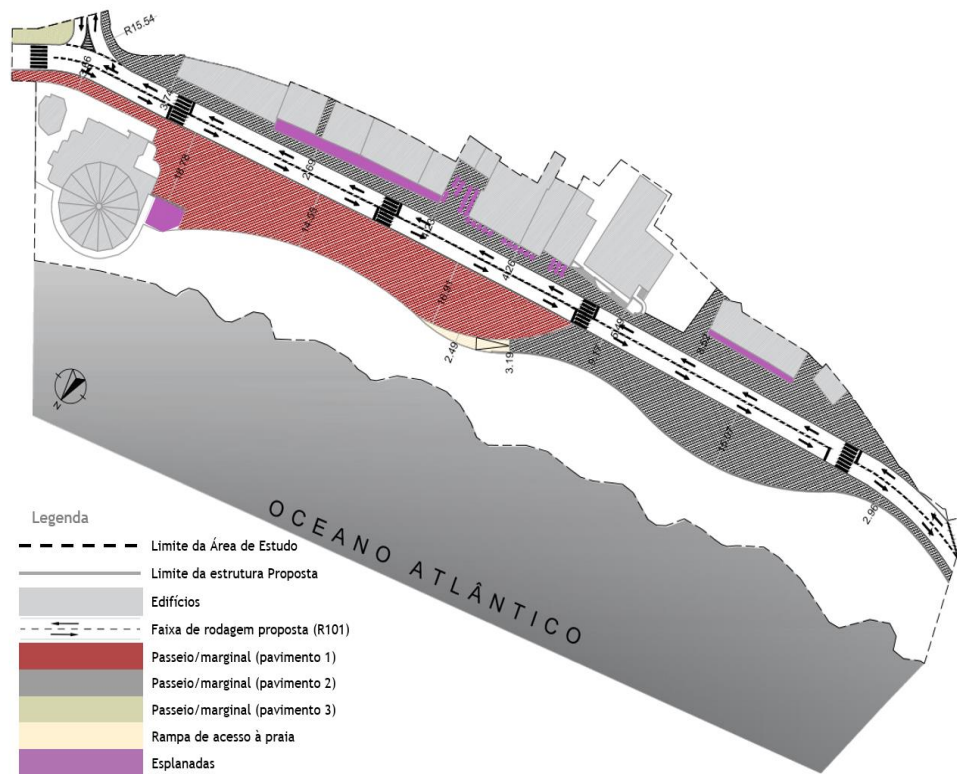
Planta esquemática: Zona do Calhau. Circulação pedonal. [s/escala]
